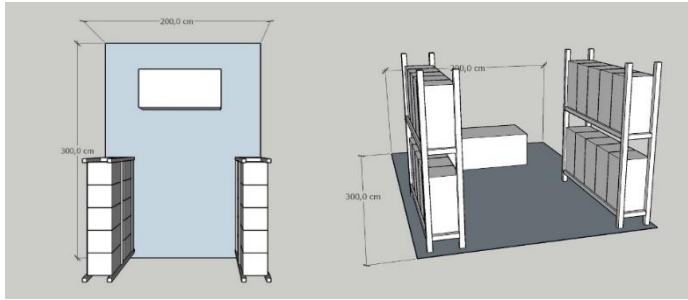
16 Layout Ruang Kios Ikan Tipe B
